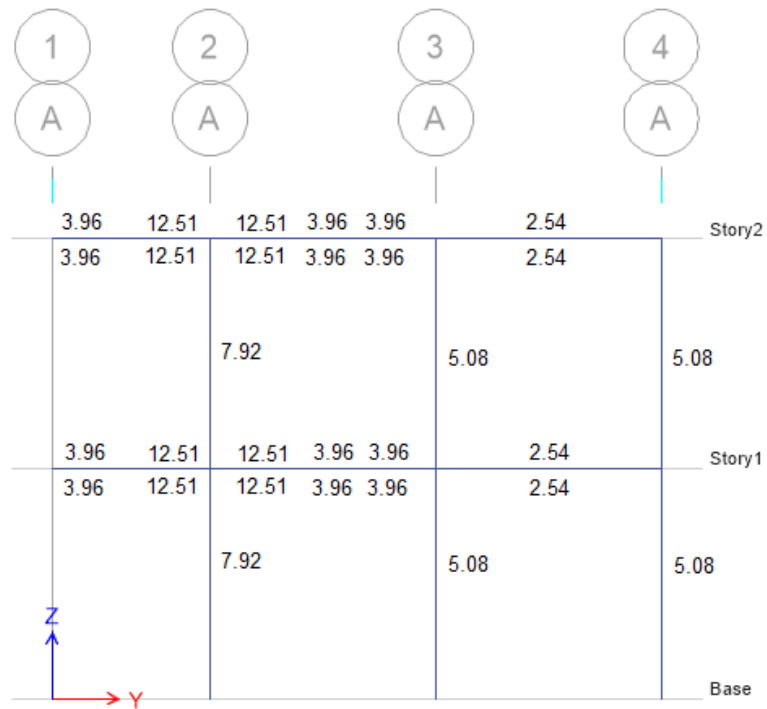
Acero en vigas y columnas ejes A, C, E y G.
